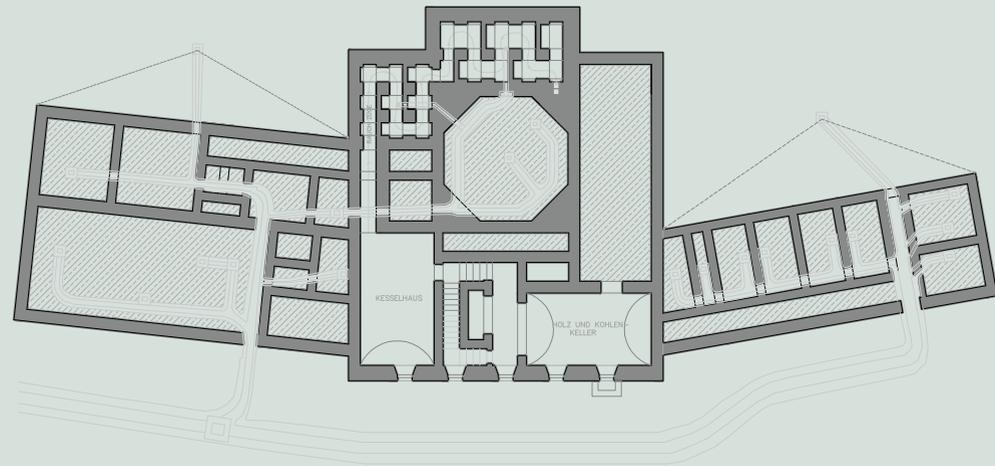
Keller - Grundriss des alten Hammams
